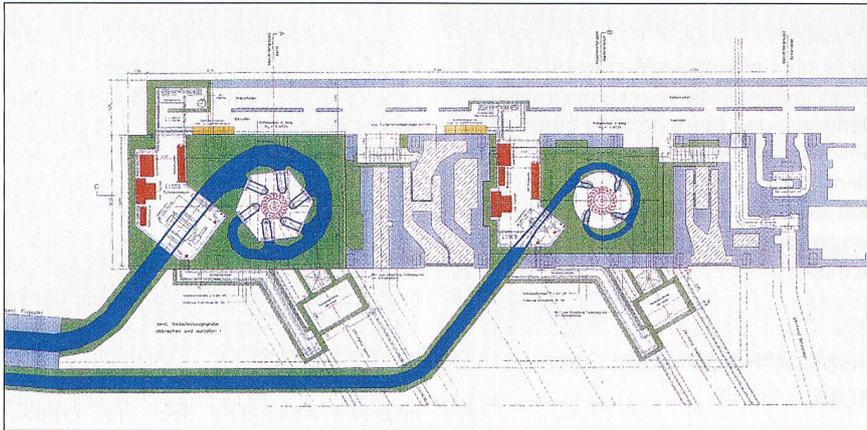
Grundriss der neuen Zentrale Schwanen.
